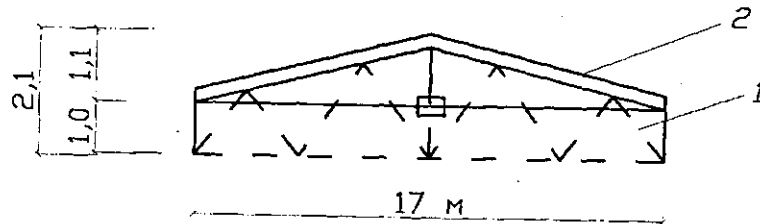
Фермы после установки дублирующих шпренгельных балок: 1 — ферма; 2 — балка с затяжкой
